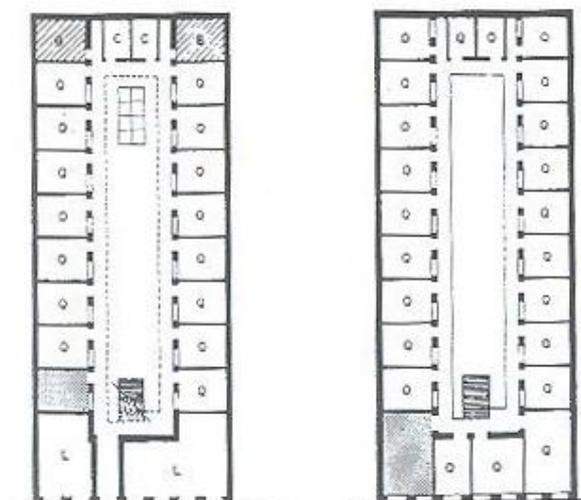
Planta típica do cortiço. VAZ, 2002, p.103.
